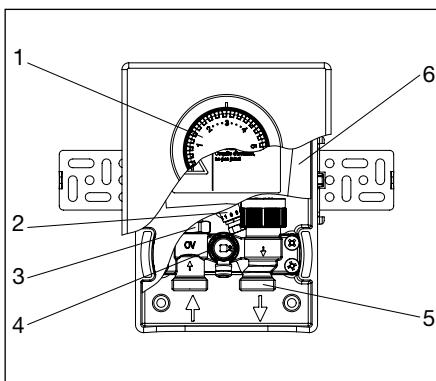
Vue d'ensemble «Unibox E BV»
